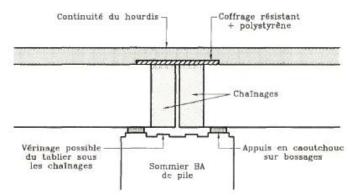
Coupe longitudinale sur appui d'un tablier à poutres à travées indépendantes
